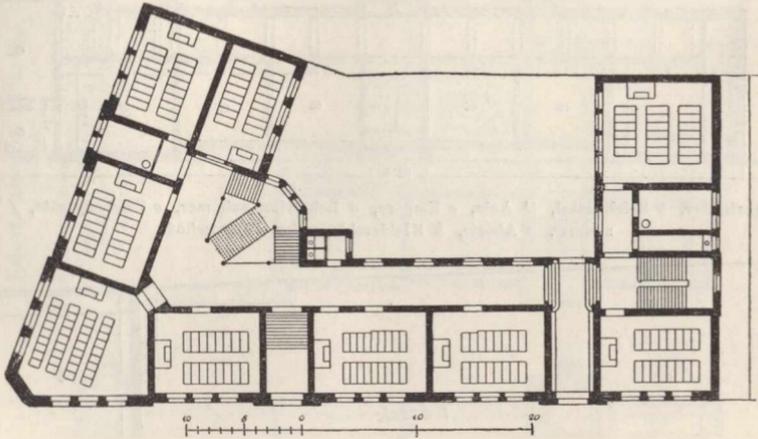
Grundriß vom Erdgeschoß der Jakobsschule in Stuttgart (s. S. 639).
